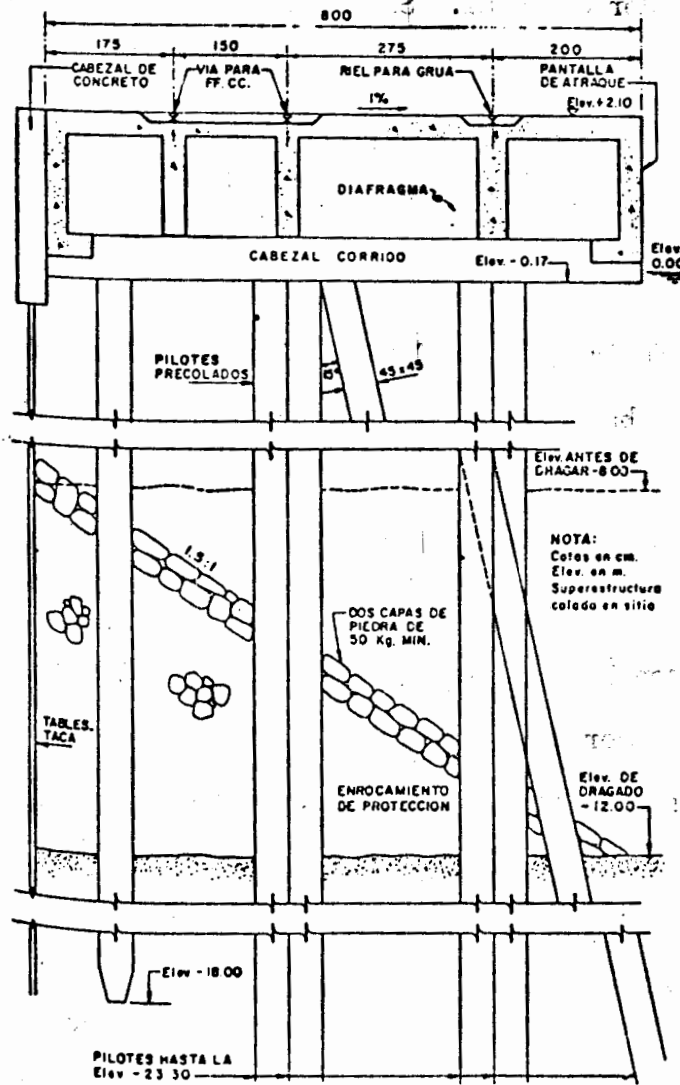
Muelle de pilotes de concreto y tablestaca metálica.
